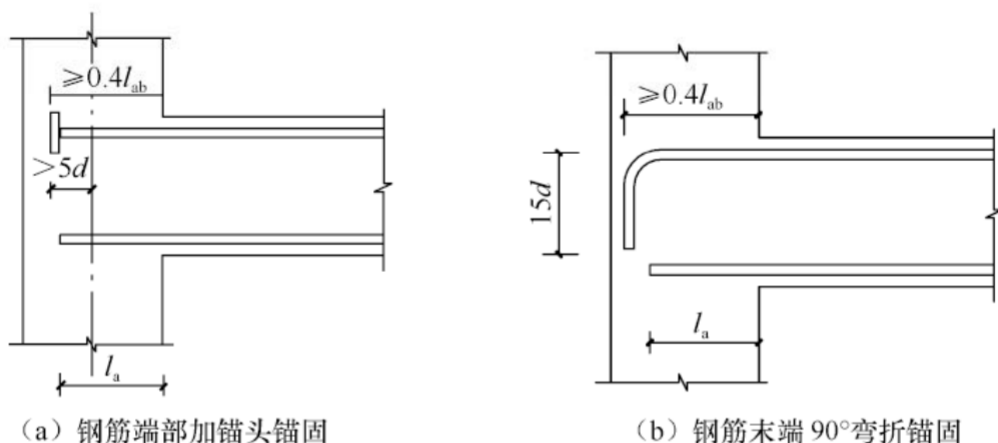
梁上部纵向钢筋在中间层端节点内的锚固
